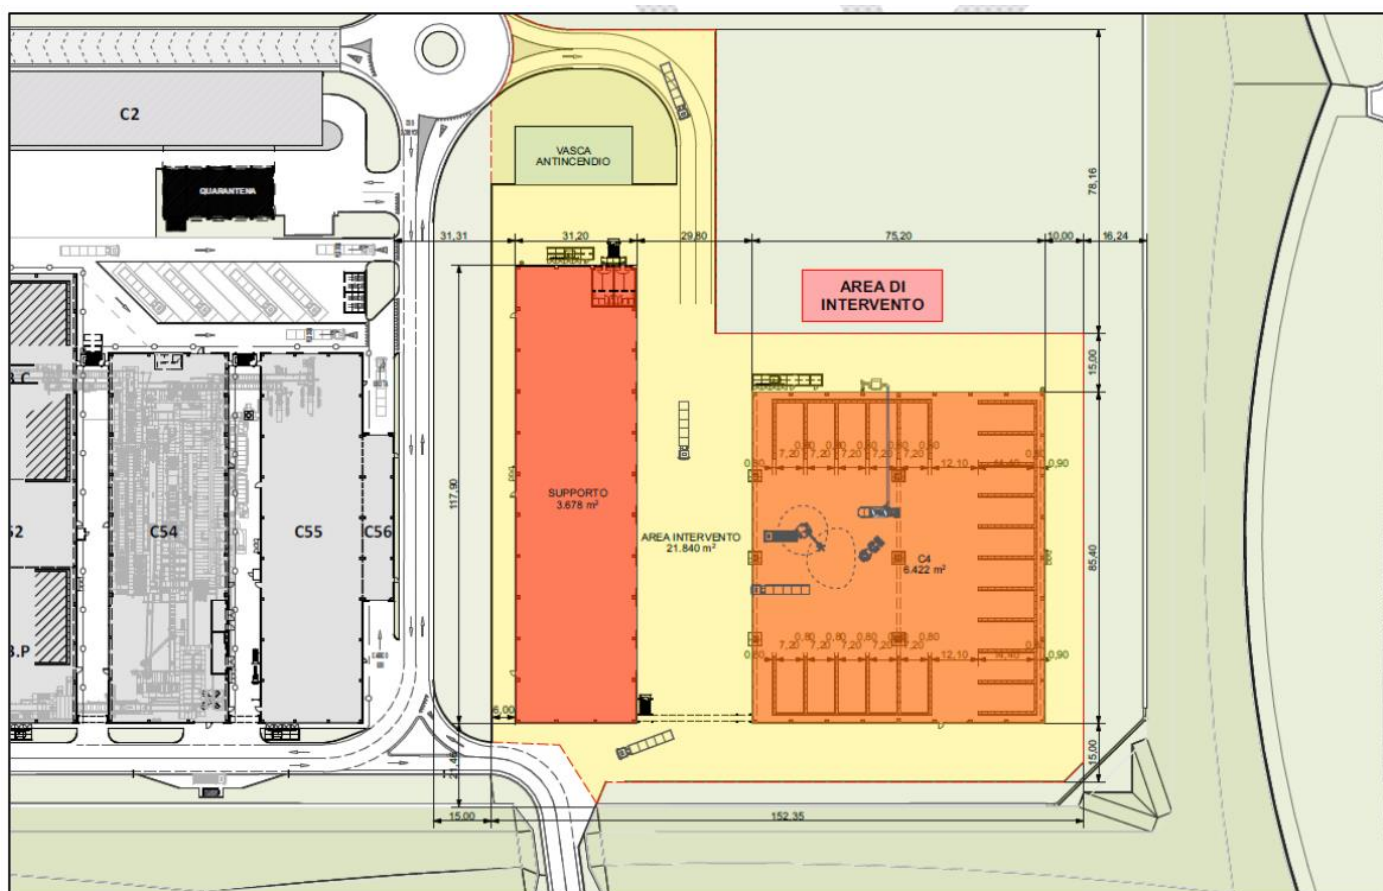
Stralcio planimetria in progetto (aggiornato a Settembre 2023).
